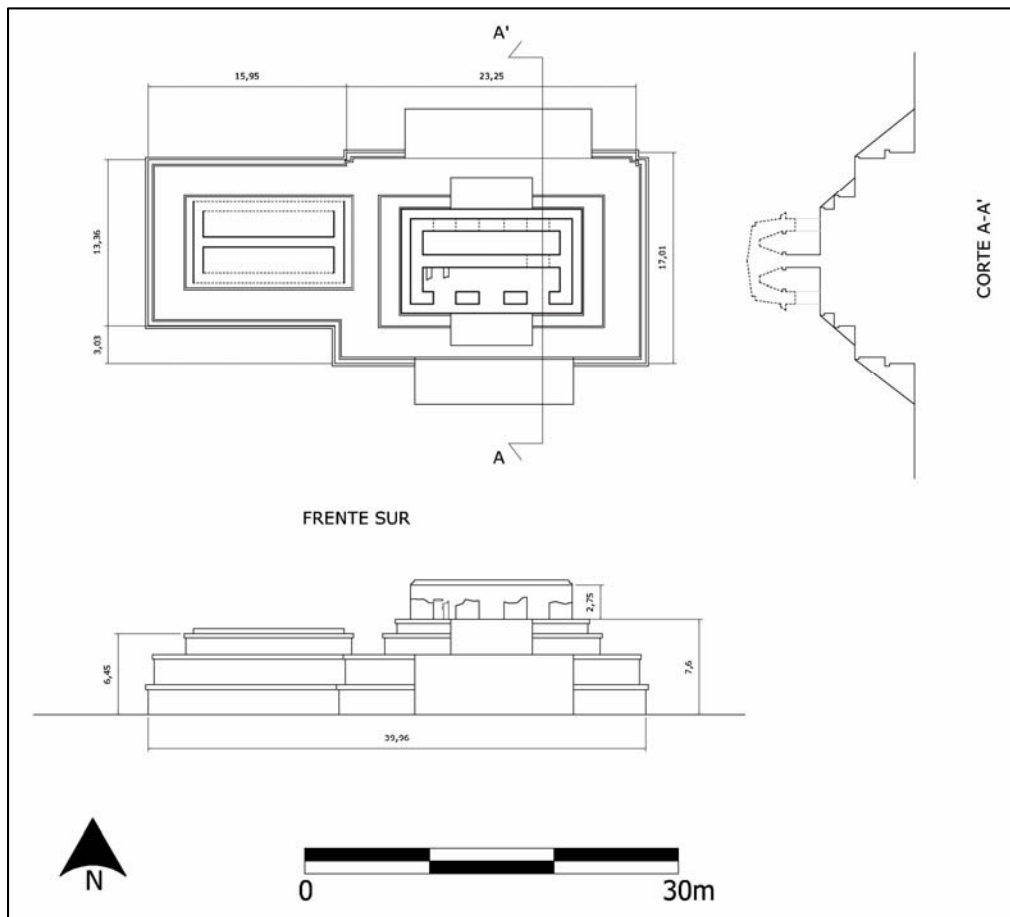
Levantamiento y propuesta reconstructiva del corte, estructura A-9 (PRACH-elaboración A. Campiani)
